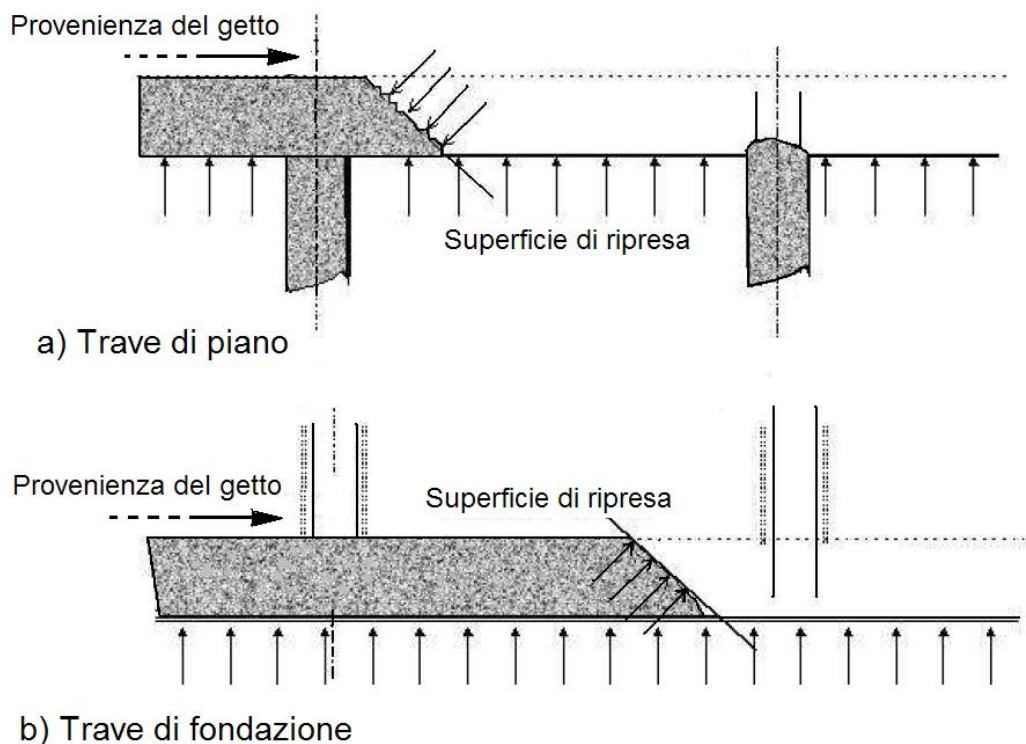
Modalità di ripresa del getto in travi di piano e di fondazione
